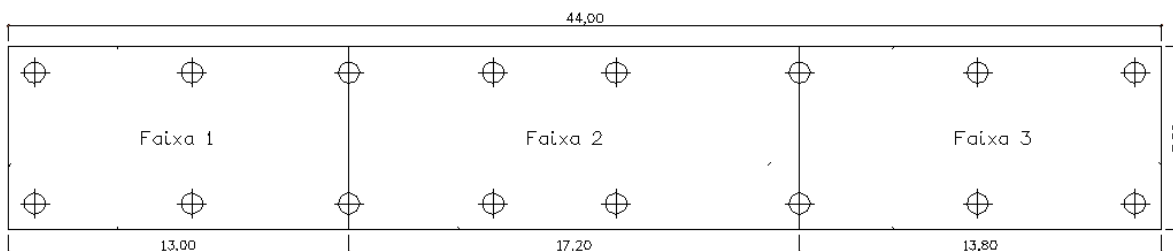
Identificação das faixas na laje de ensoleiramento – Armaduras Inferiores.
